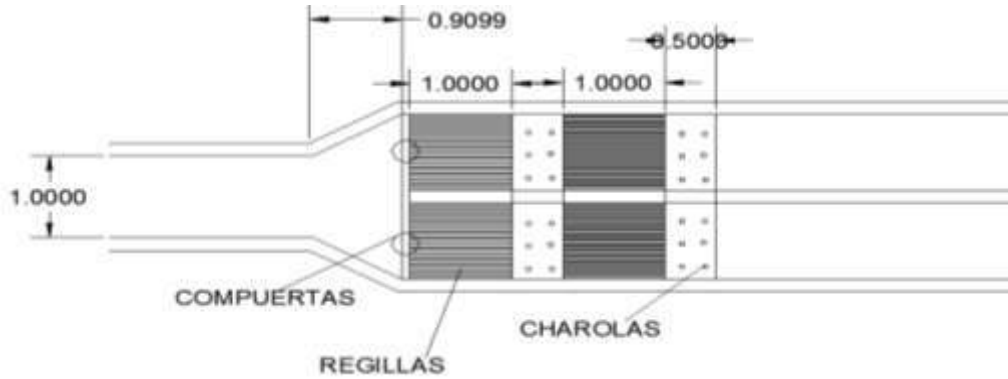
vista en planta de la transición entre canal de aproximación y rejillas.
